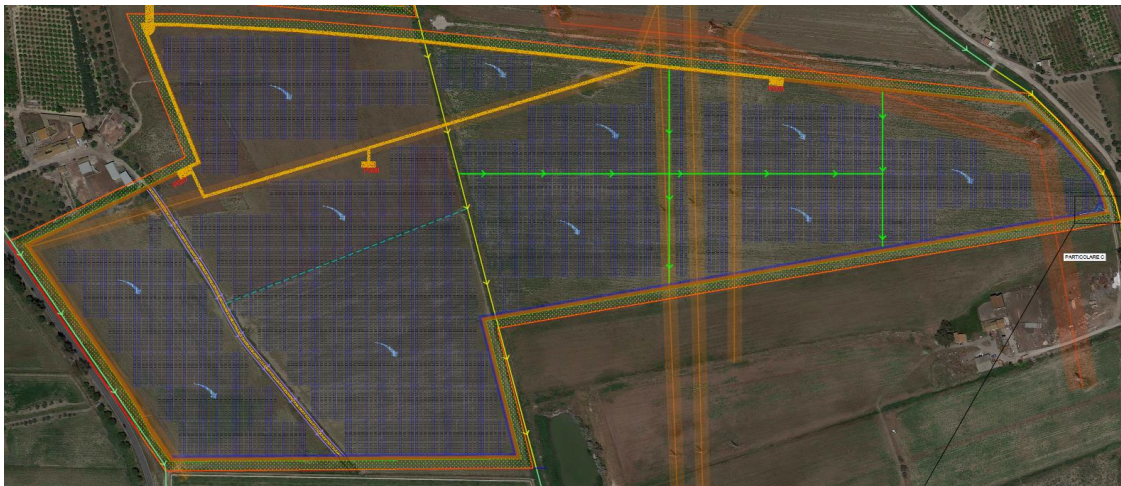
Sistema di drenaggio acque meteoriche – Planimetri Area Sud – Stralcio tavola progettuale
